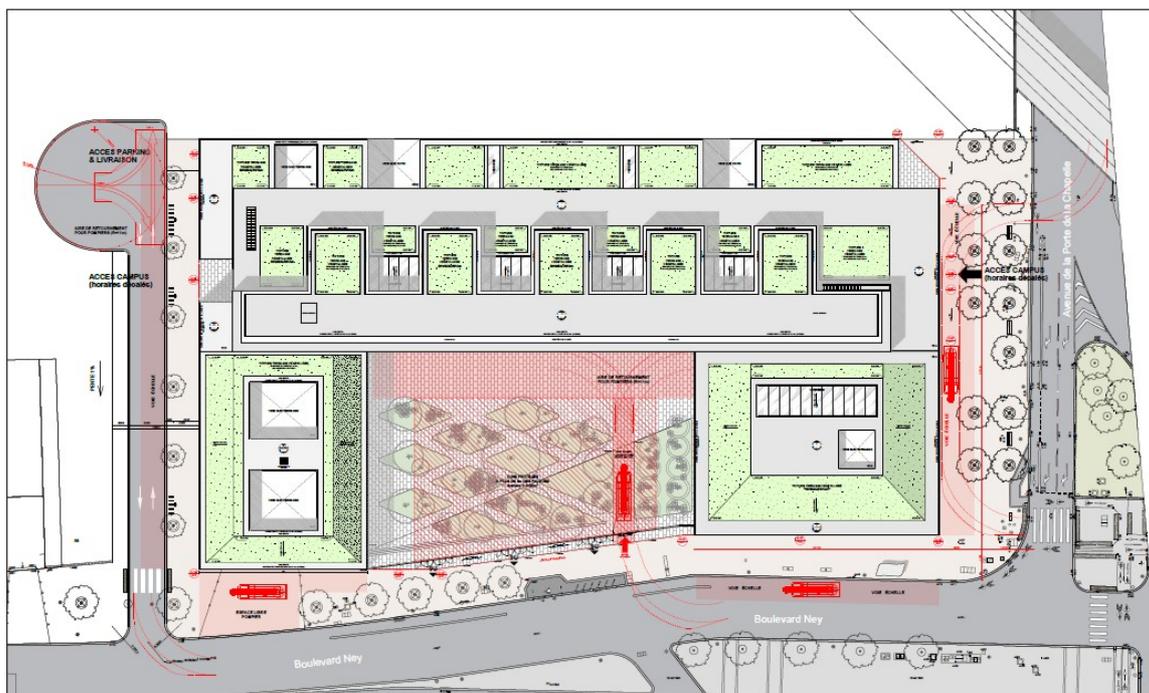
Plan de masse du projet Condorcet sur le site de La Chapelle (extrait du PC2a)
